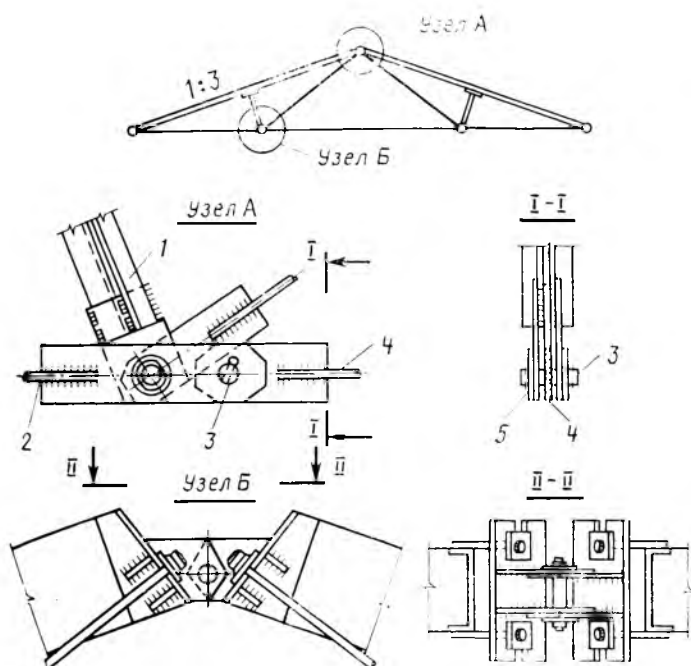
Схема сталежелезобетонной фермы на основе шпренгельных балок и узлы сопряжения конструктивных элементов
